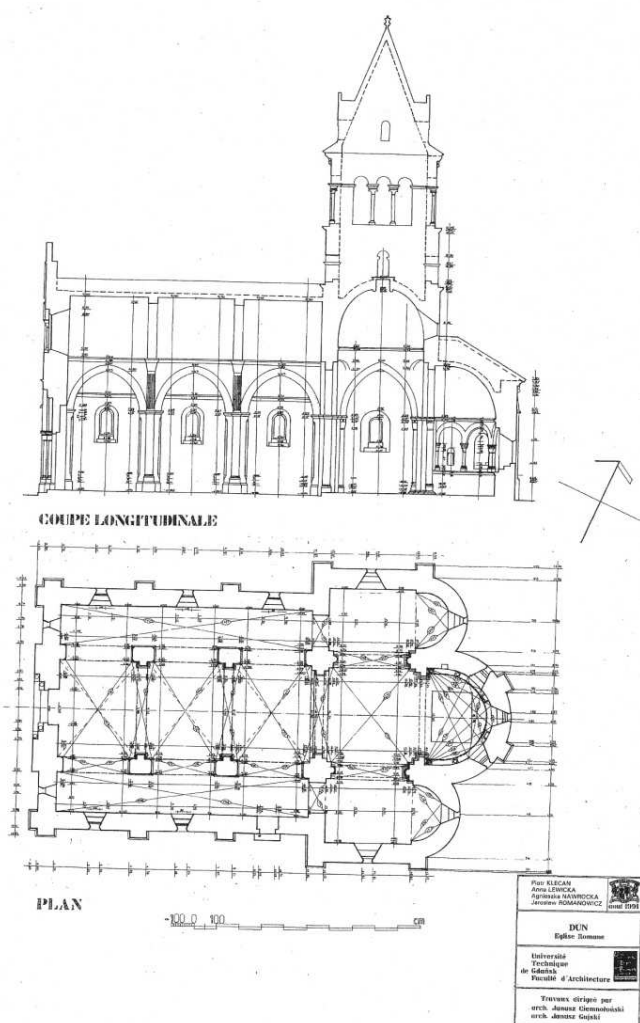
Coupe longitudinale et plan de l'église de Dun (CEP)
